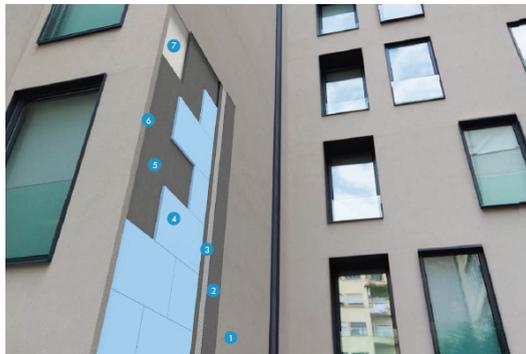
Esquema de soluciones constructivas para SATE en fachadas. (Leyenda: 1 Revestimiento de sistema REVESTIDAN® SATE; 2 Capa base de mortero ARGOTEC® Fixtherm; 3 Armadura de fibra de vidrio Malla PX 160; 4 Aislamiento térmico DANOPREN® FS; 5 Adhesivo de mortero ARGOTEC® Fixtherm; 6 Cerramiento de fachadas; 7 Yeso).
